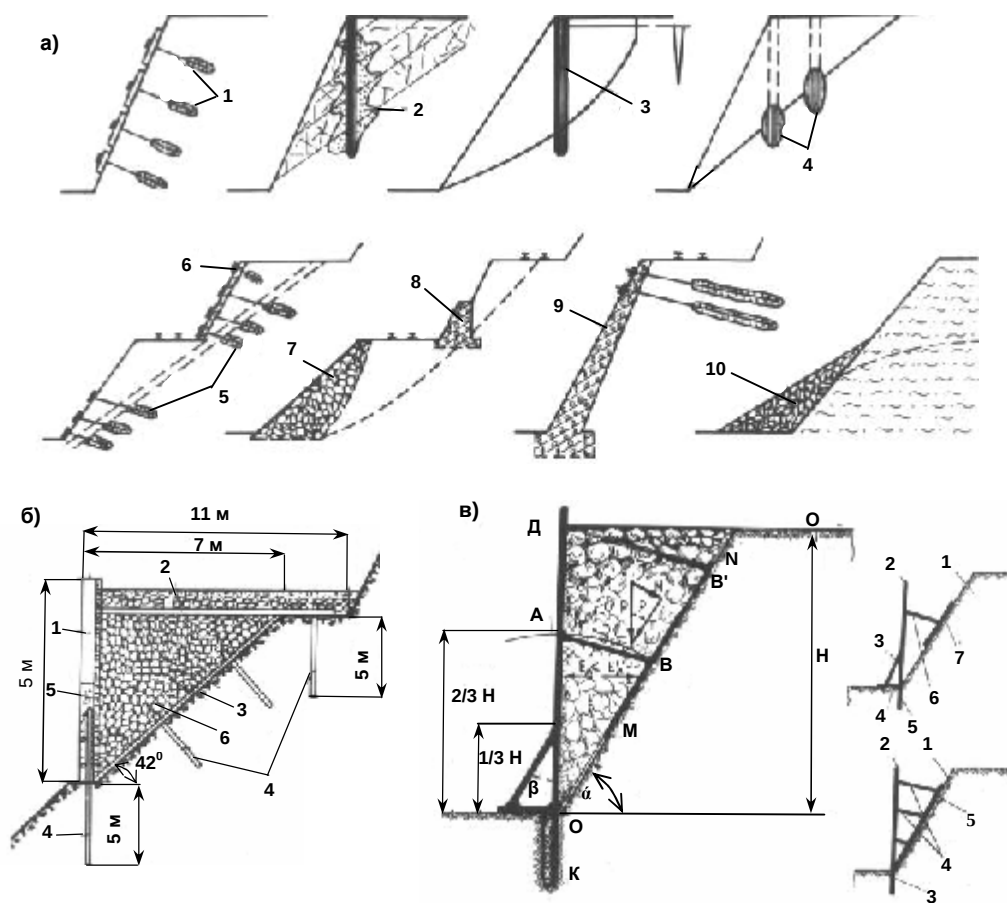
Способы увеличения устойчивости откосов и создания искусственных бERM: а) Механические способы укрепления откосов: 1-железобетонные штанги; 2-железобетонная свая и цементация; 3-трубчатая свая большого диаметра; 4-железобетонные шпоны; 5-тросовые тяжи; 6-подвесная железобетонная стенка; 7-контрфорс из скальных пород; 8-железобетонная подпорная стенка; 9- железобетонная защитная стенка; 10- пригрузка из дренирующего материала (ВНИМИ,1974), б) Конструкция искусственной бермы (Унипромедь, 1975), в) Подпорная крепь
